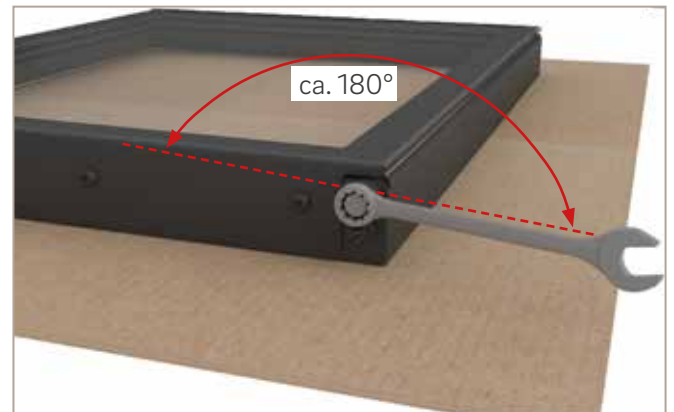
Türfeder mit Maul-/Ringschlüssel vorspannen
